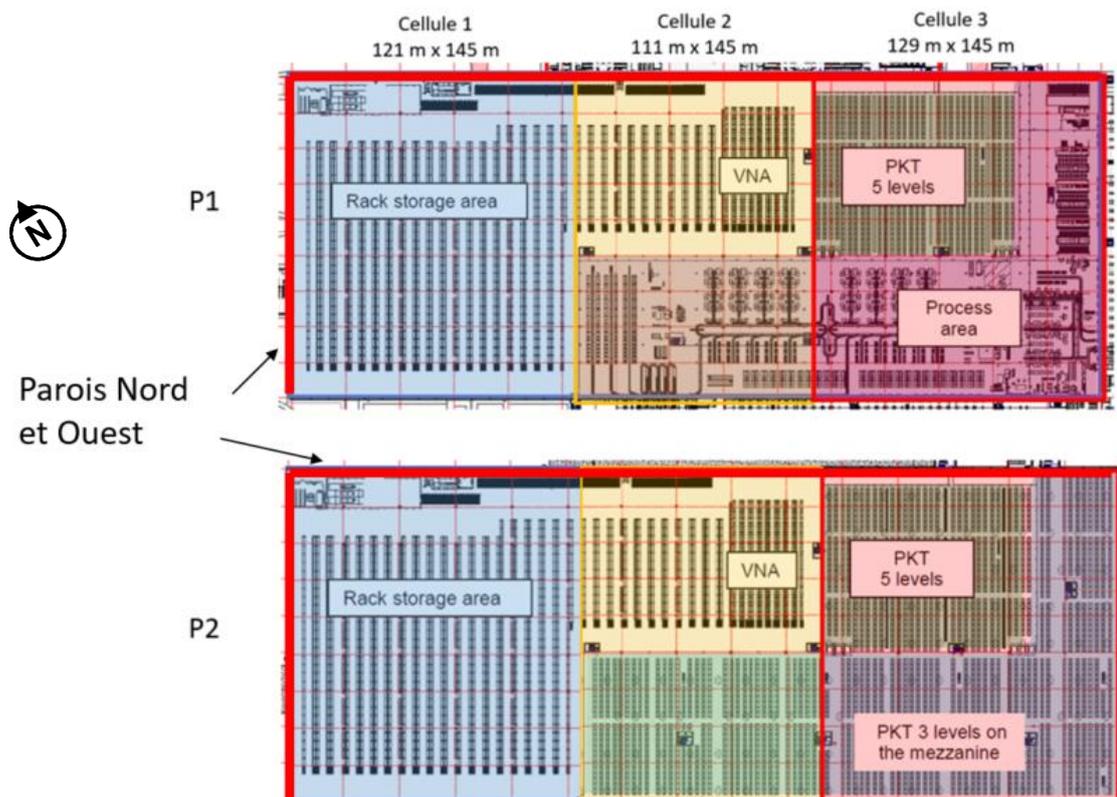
Façades Nord et Ouest : stockage toute hauteur
